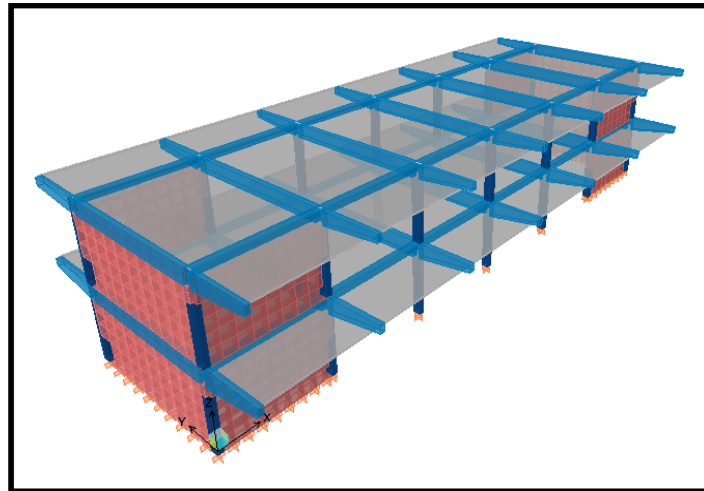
I Vista en 3D de la Propuesta de Reforzamiento
